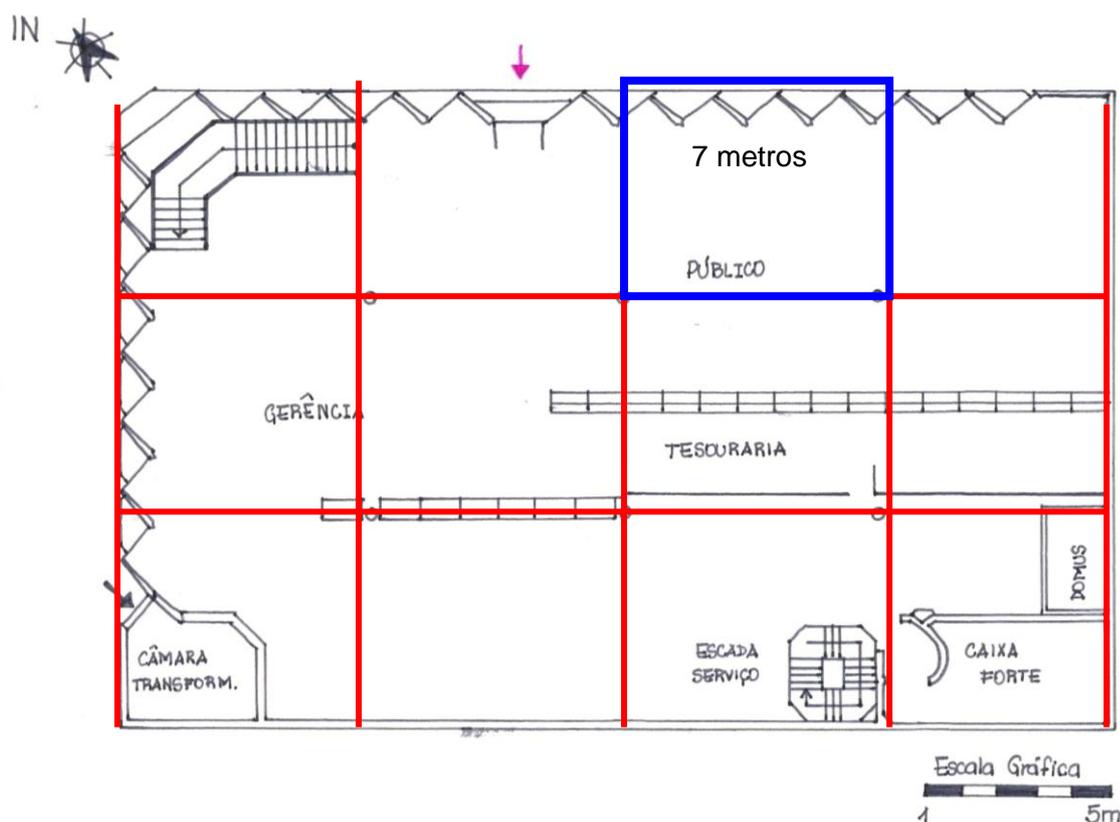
Planta baixa esquemática da edificação – Pavimento Térreo.
